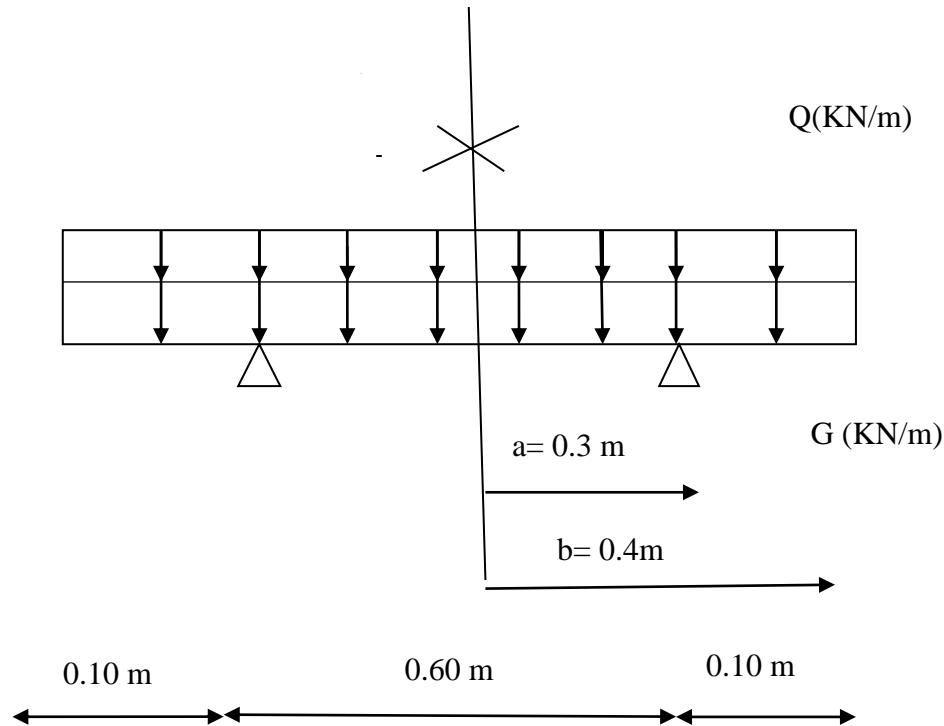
Schéma statique de la dalle reposant sur le voile.
